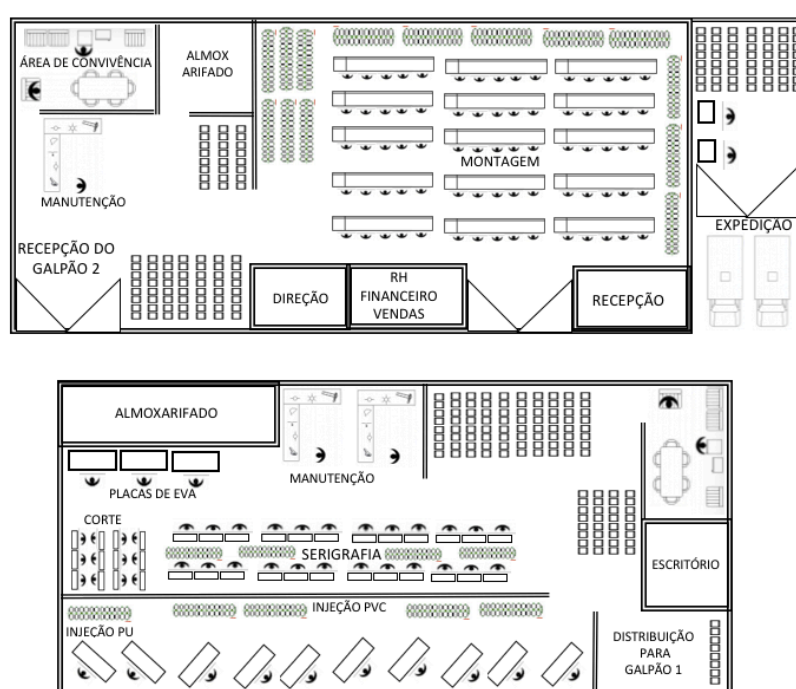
Esquema da planta de situação dos dois galpões da empresa
